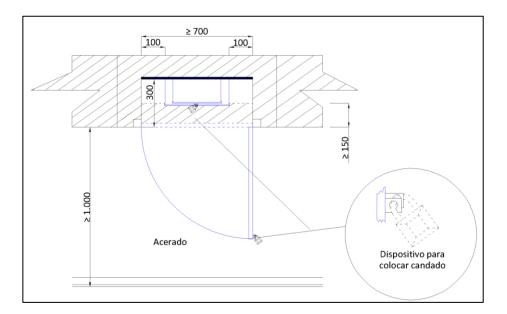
Instalación CGP y CS montaje vertical. Planta.
